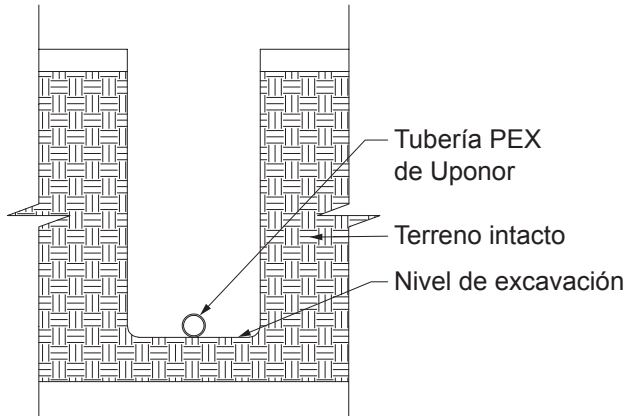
Buenas condiciones del suelo — Si la zanja se excava lisamente, instale la tubería directamente en el fondo preparado. El fondo tiene que ser plano, sin huecos, bultos o piedras.
